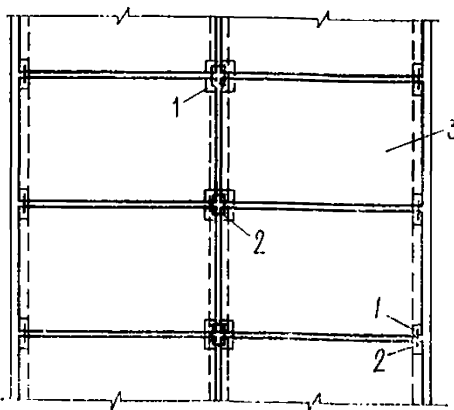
Схема неразрезного сборного перекрытия со сварными соединениями:
